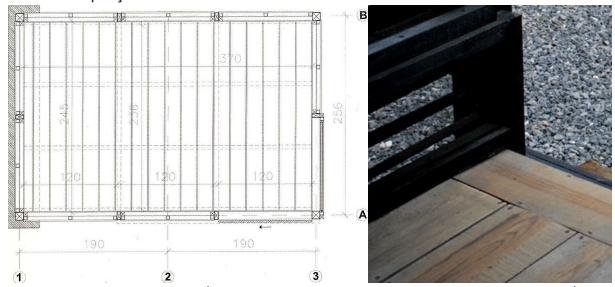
PLANTA-BAIXA (MÓDULO 10X10). FONTE: S-AR (2006)
